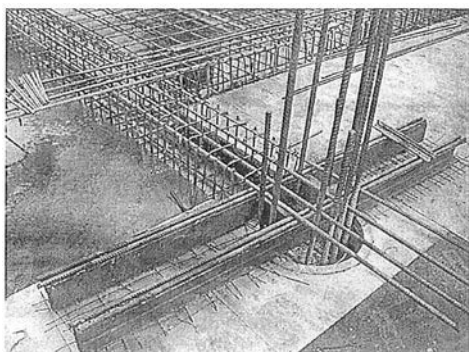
Распределительная система с жесткой арматурой без дополнительного поперечного армирования
